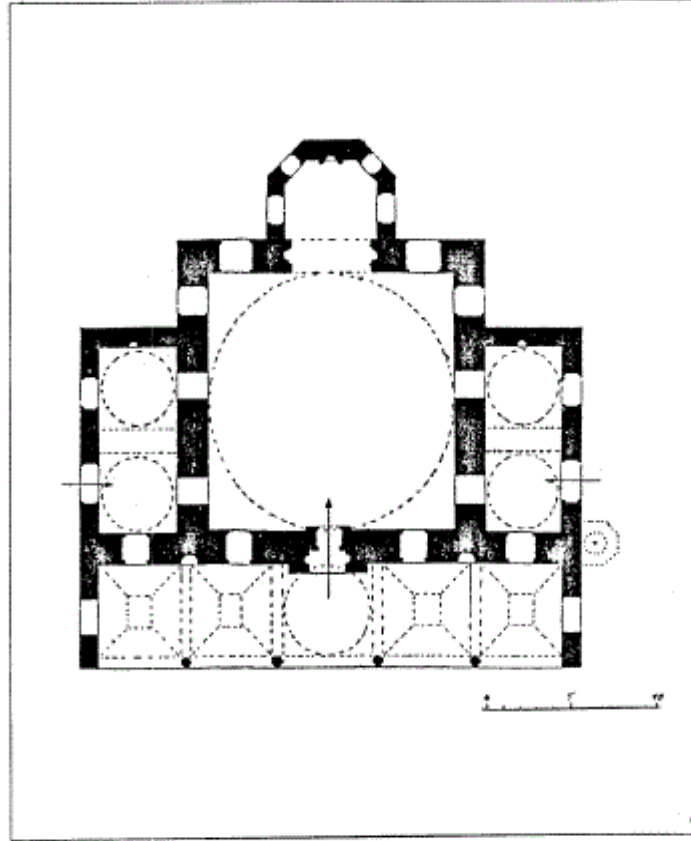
مسقط أفقي للمسجد القديم (اسكى جامع) في كوموتينى (عن : كبل) .
